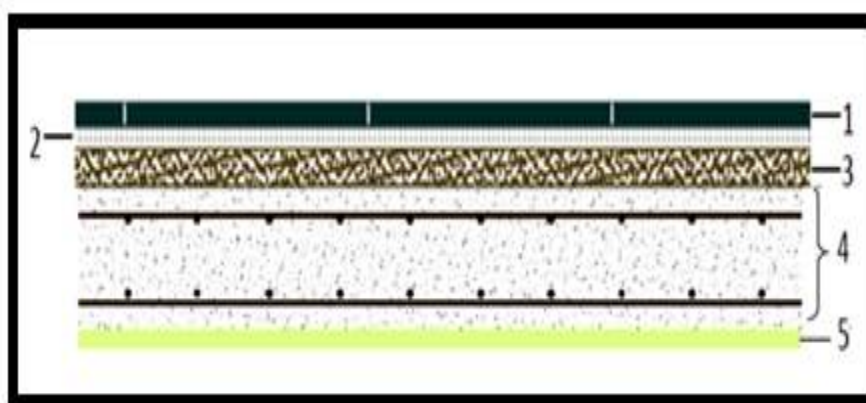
Composants d'un plancher étage courant (dalle pleine).
